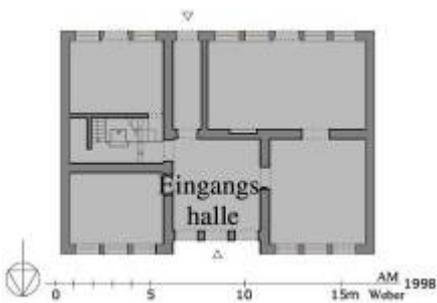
Bayt Ġabrī [988], Grundriss EG
